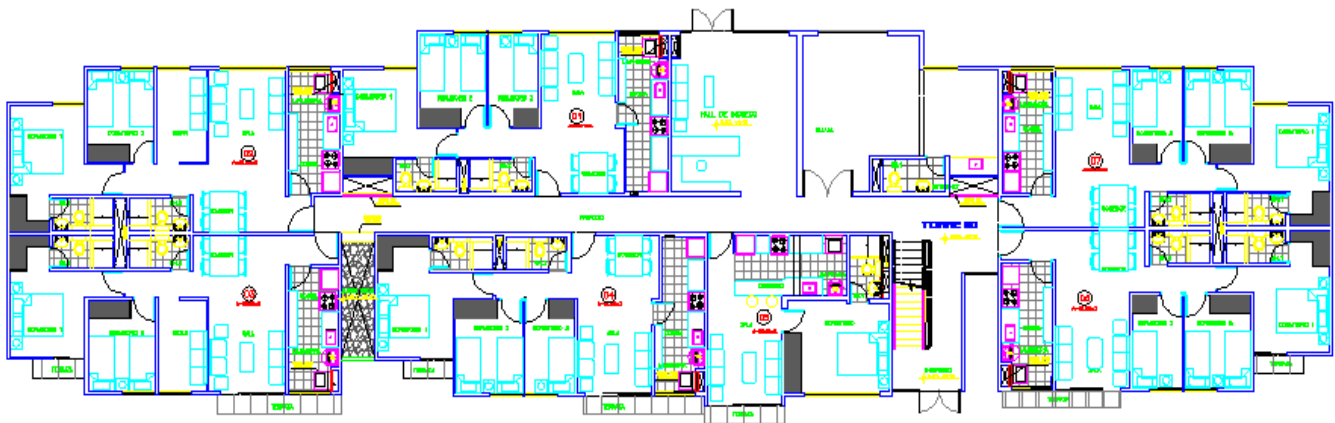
DISTRIBUCIÓN ARQUITECTÓNICA DE PRIMERA PLANTA
